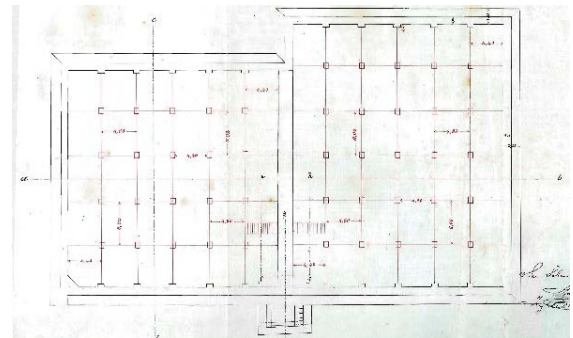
Planta de Buscando (Archivo Municipal)
